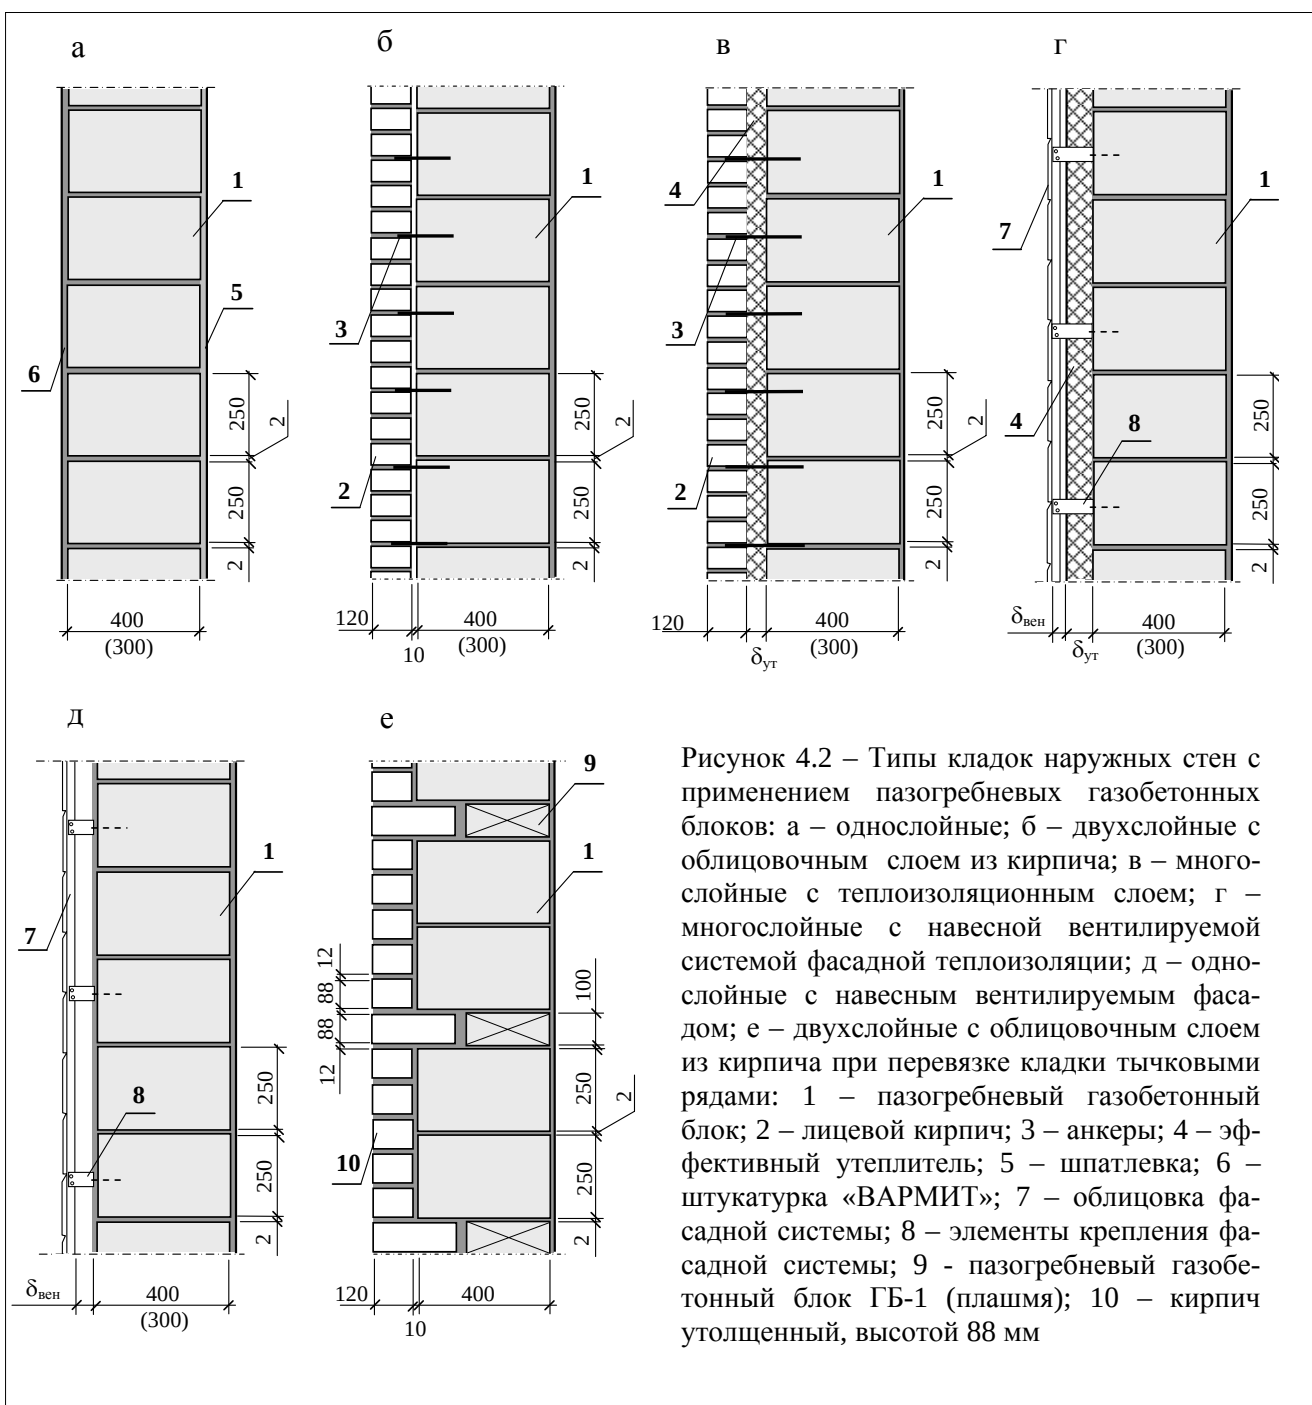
Типы кладок наружных стен с применением пазогребневых газобетонных блоков: а – однослойные; б – двухслойные с облицовочным слоем из кирпича; в – многослойные с теплоизоляционным слоем; г – многослойные с навесной вентилируемой системой фасадной теплоизоляции; д – однослойные с навесным вентилируемым фасадом; е – двухслойные с облицовочным слоем из кирпича при перевязке кладки тычковыми рядами: 1 – пазогребневый газобетонный блок; 2 – лицевой кирпич; 3 – анкеры; 4 – эффективный утеплитель; 5 – шпатлевка; 6 – штукатурка «ВАРМИТ»; 7 – облицовка фасадной системы; 8 – элементы крепления фасадной системы; 9 – пазогребневый газобетонный блок ГБ-1 (плашмя); 10 – кирпич утолщенный, высотой 88 мм
